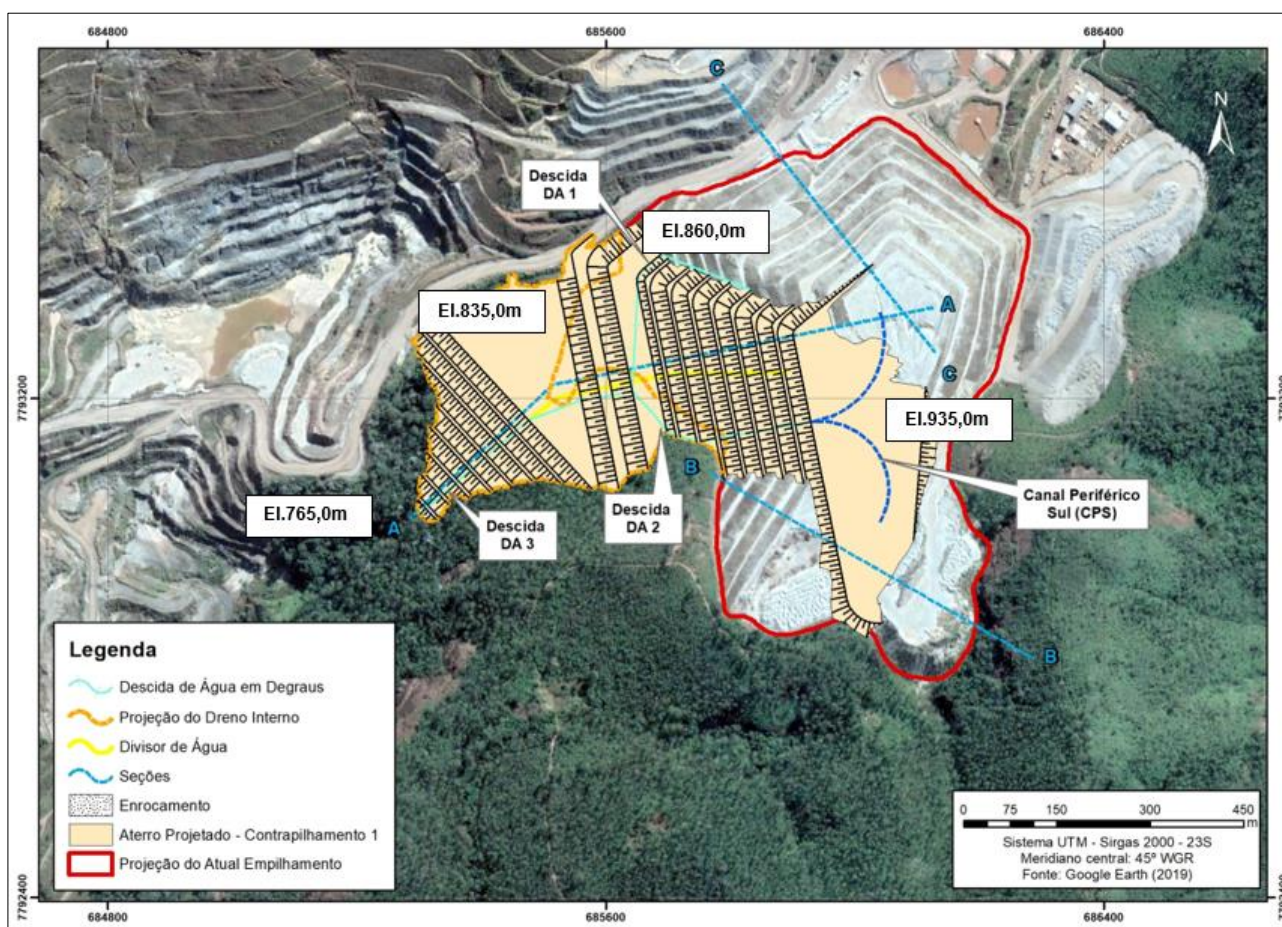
Arranjo geral da Alternativa 03 – ED Monjolo. DF+,2023.
